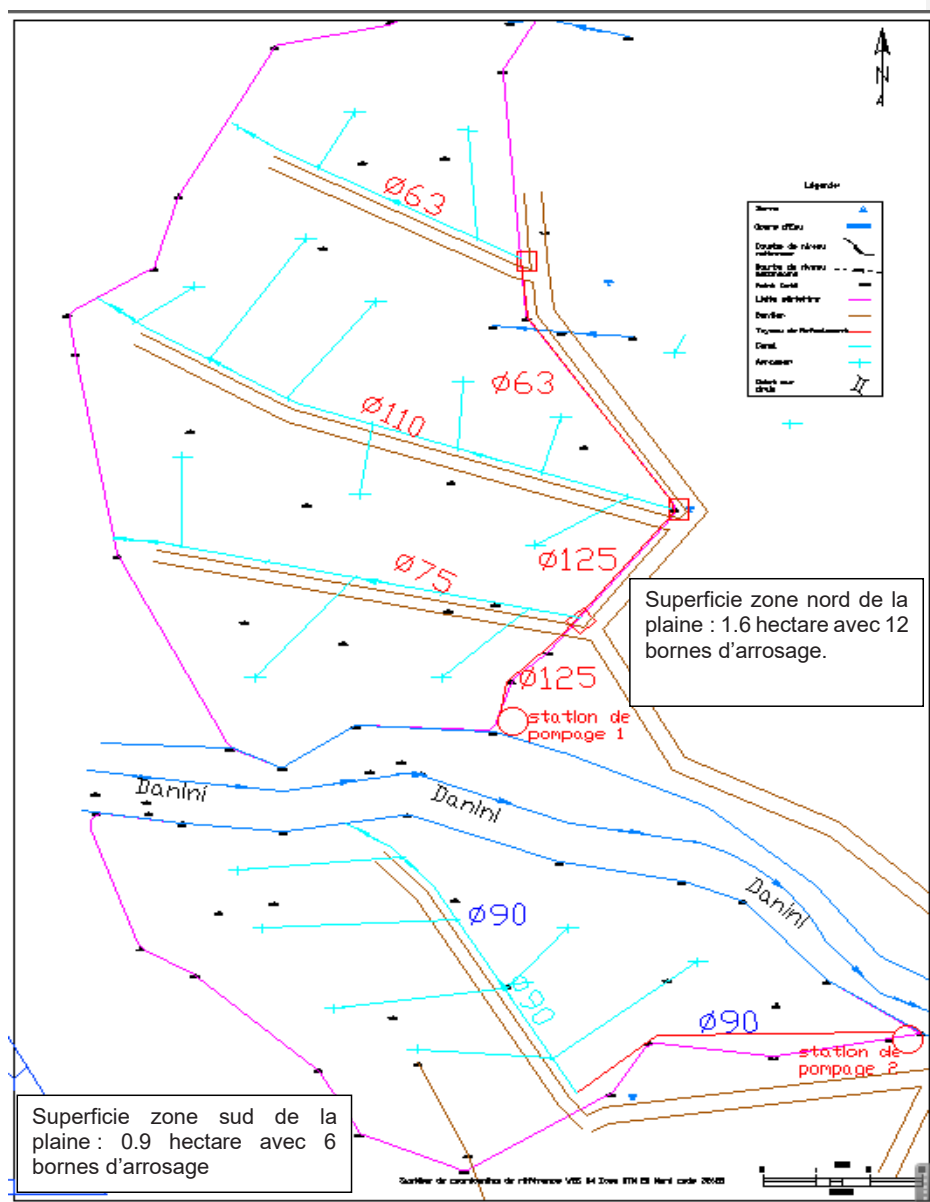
Plan de la plaine et du réseau de conduite en PVC
